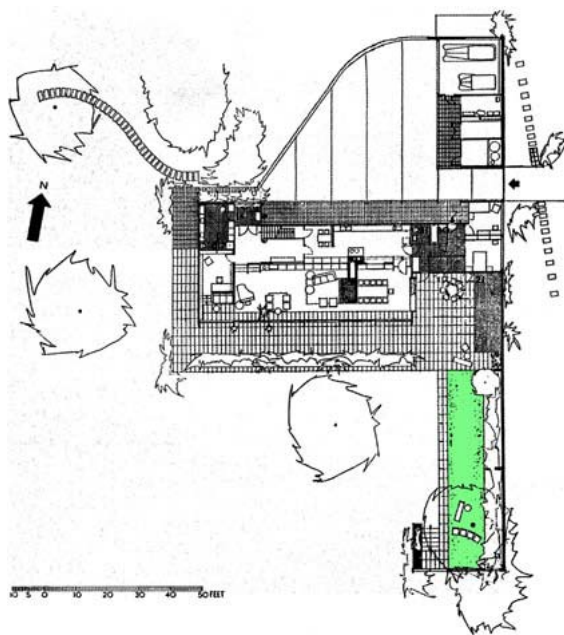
Casa Bentley Wood - planta baixa - 1935
